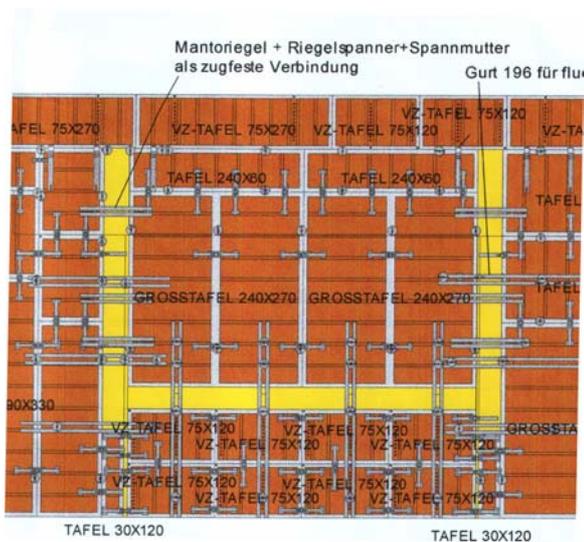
geplante Pastsstreifen zum System / Bewehrungsanschlüsse
